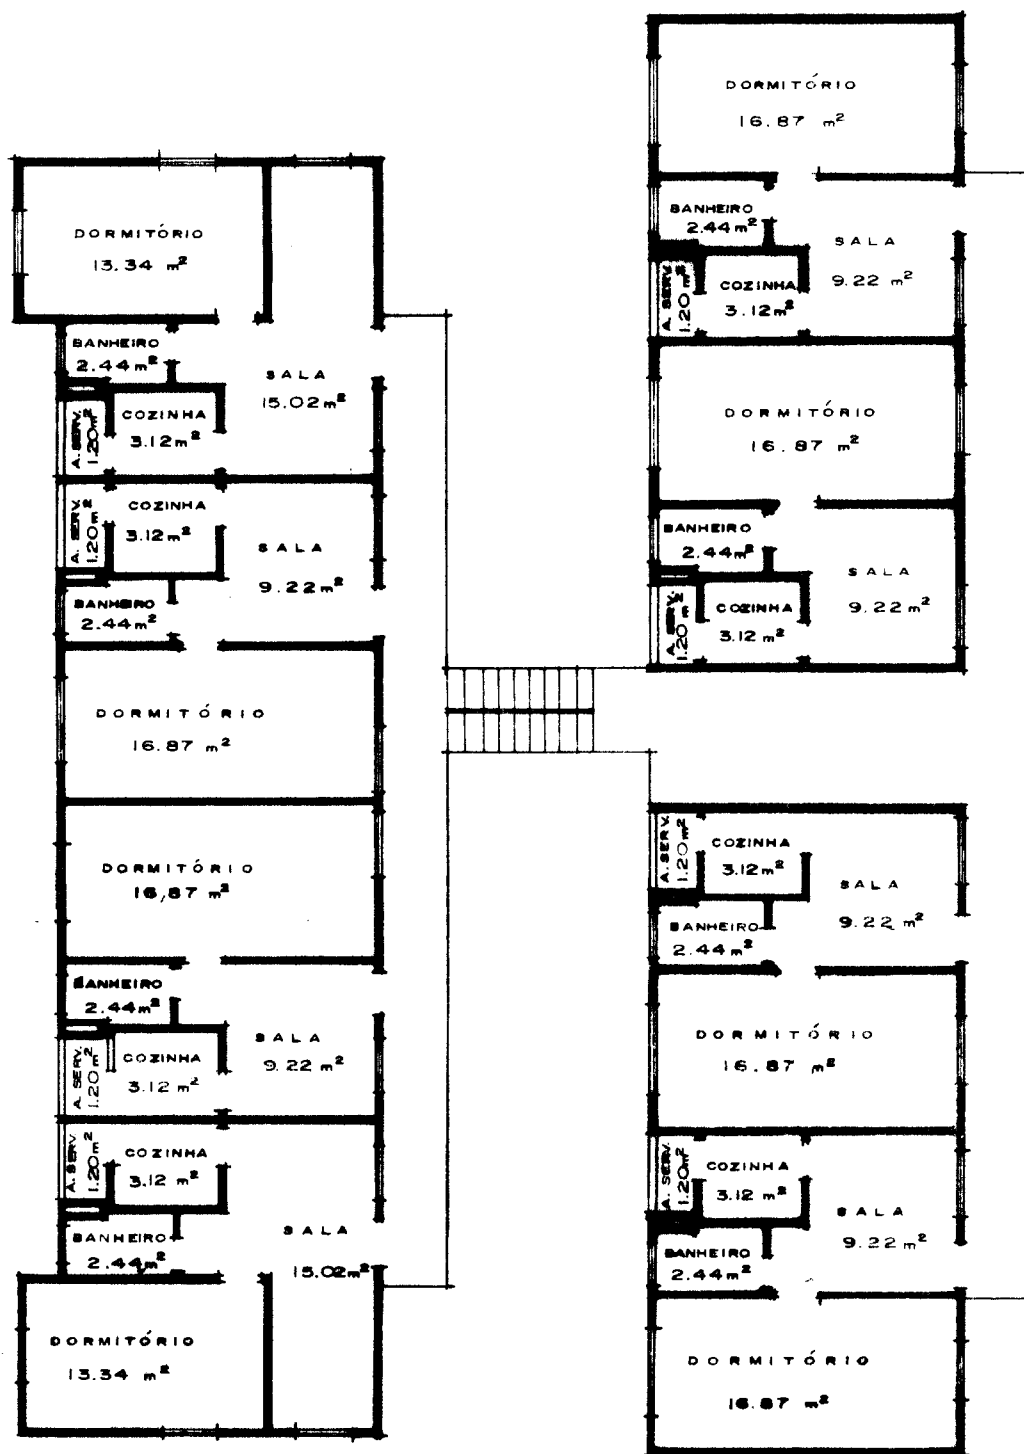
= Pavimento tipo bloco de apartamentos (tipos B e C) Conjunto Cavalhada
